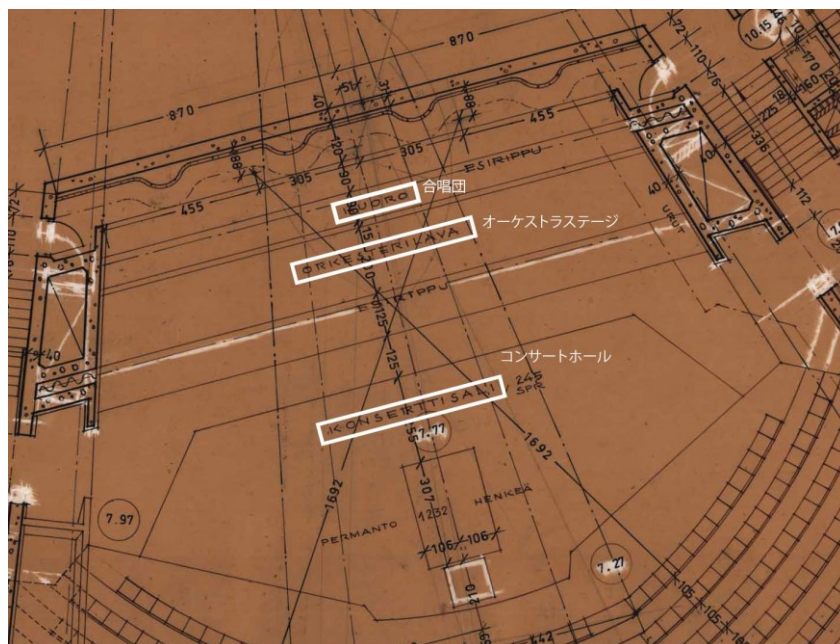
46/4877 2階平面図 舞台回り (1/100 11483×5535mm)
